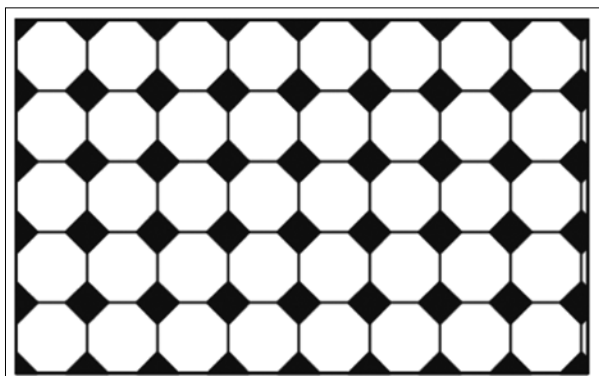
H. Pavimentazione absidale della seconda fase, ipotesi A (da GUIDOBALDI 2009).
